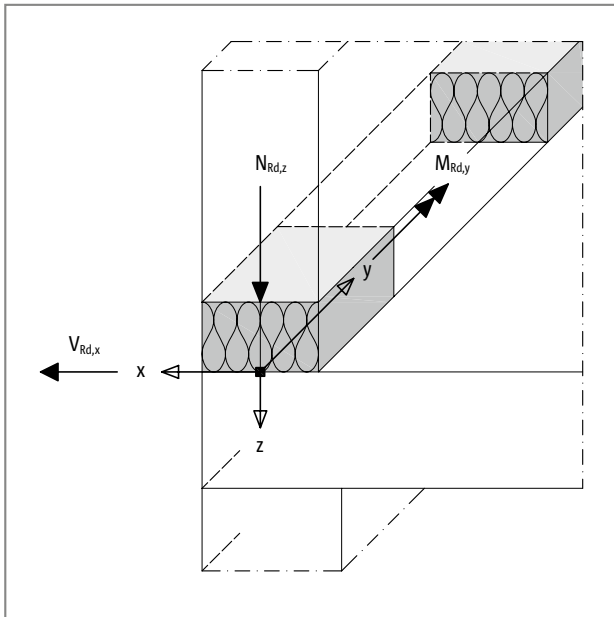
Schöck Isokorb® XT tip HP: pravilo predznaka za dimenzioniranje
